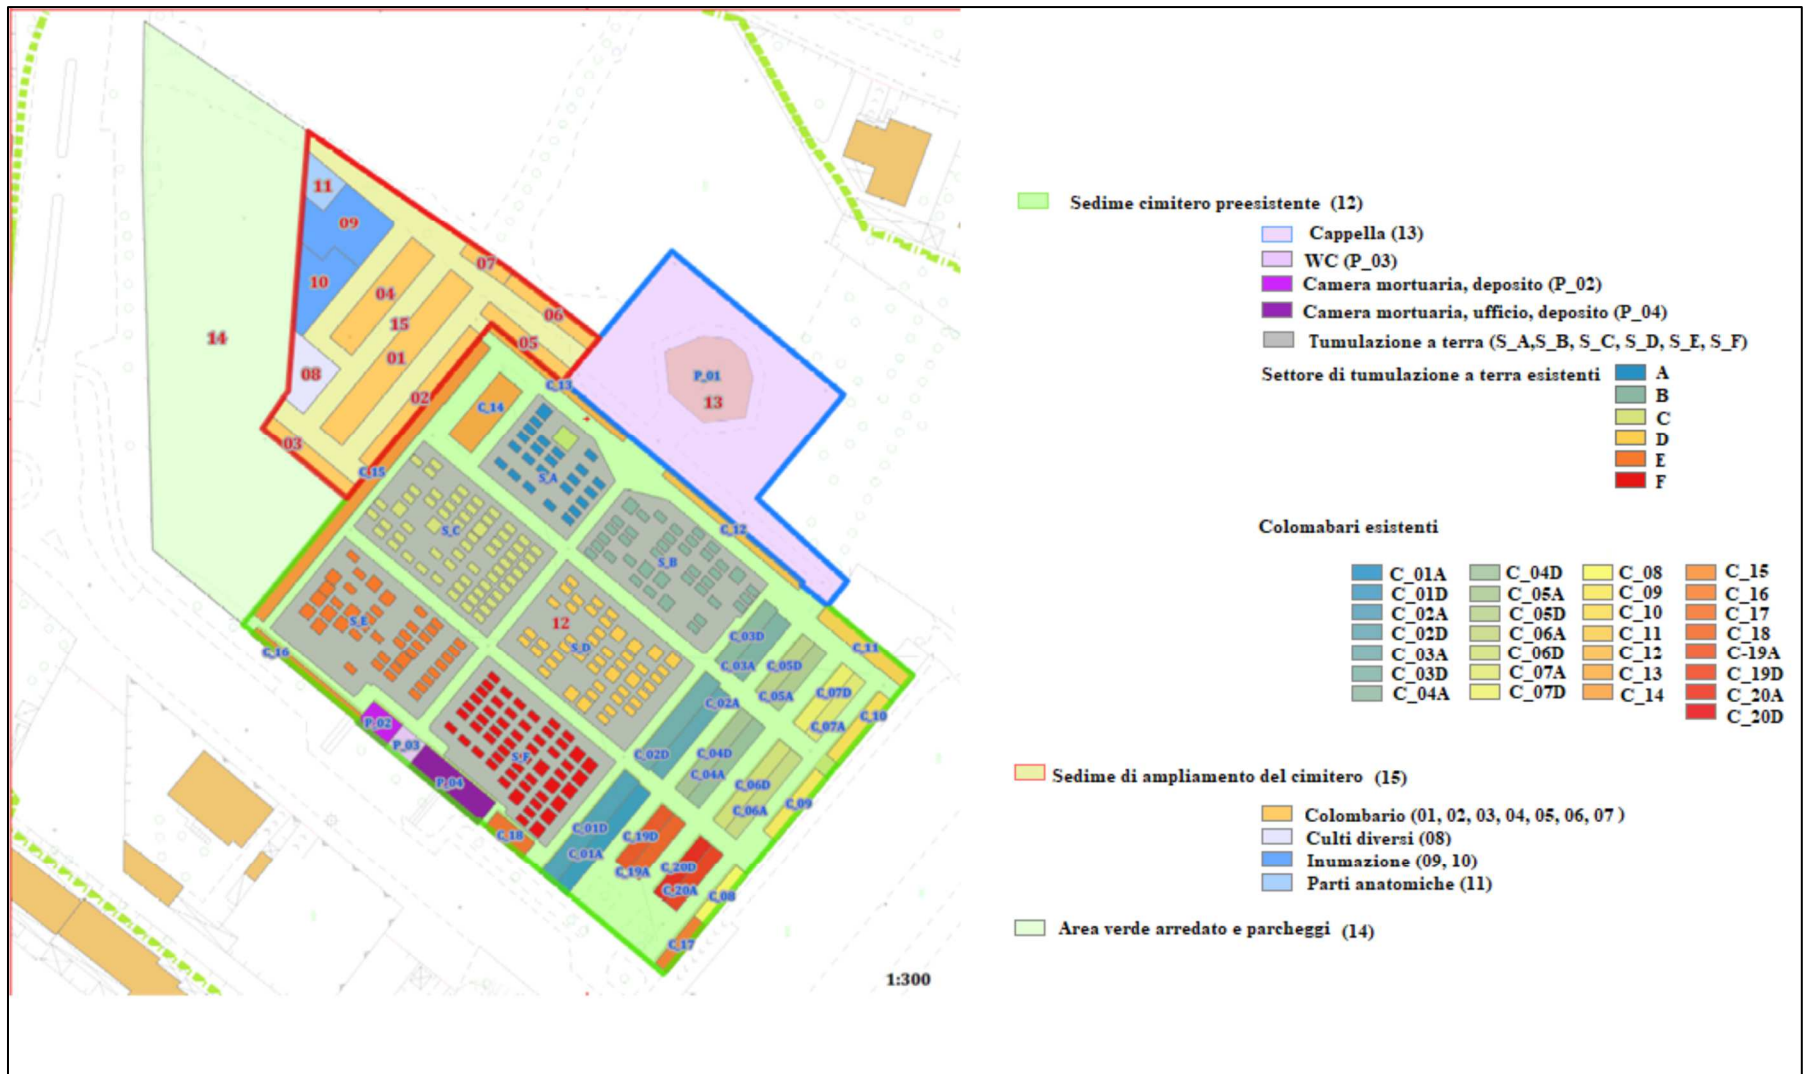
Planimetria da Piano Regolatore Generale Cimiteriale
